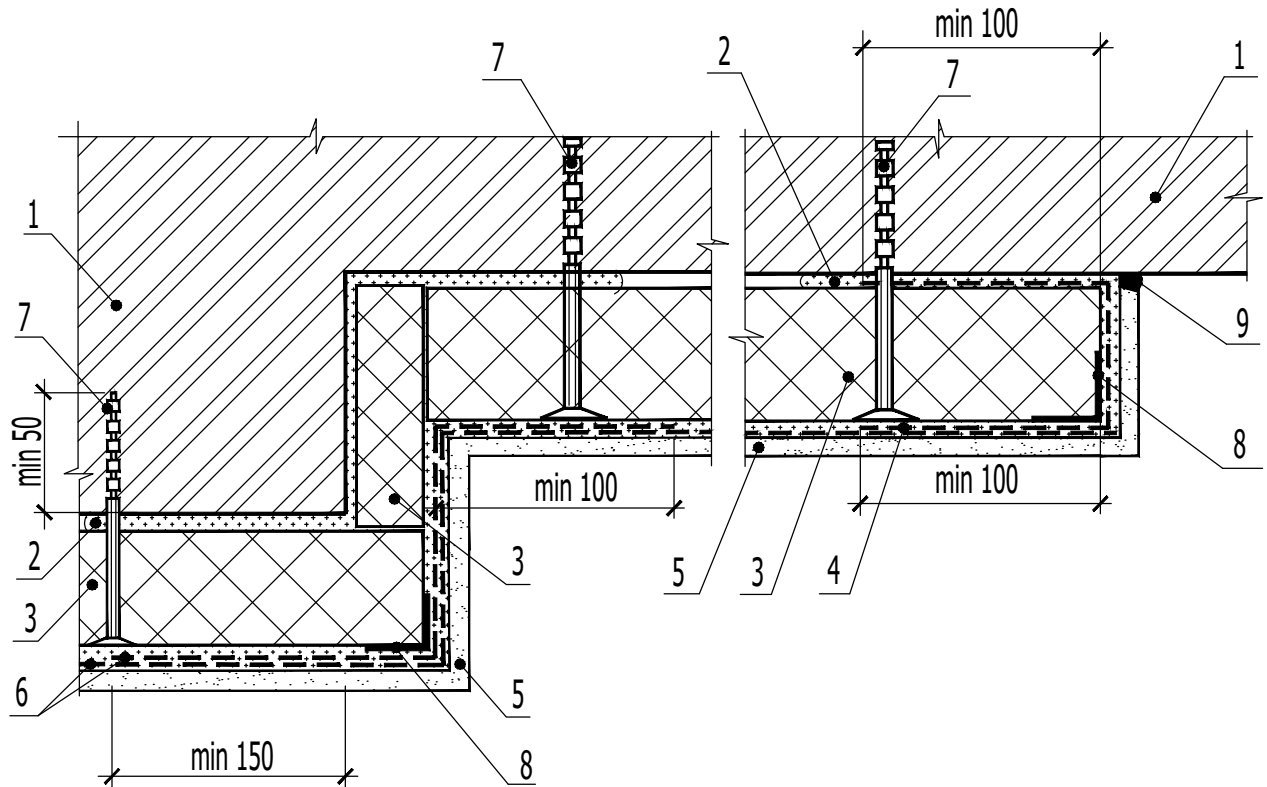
Узел отделки утепляемого верхнего откоса окна панельного здания
